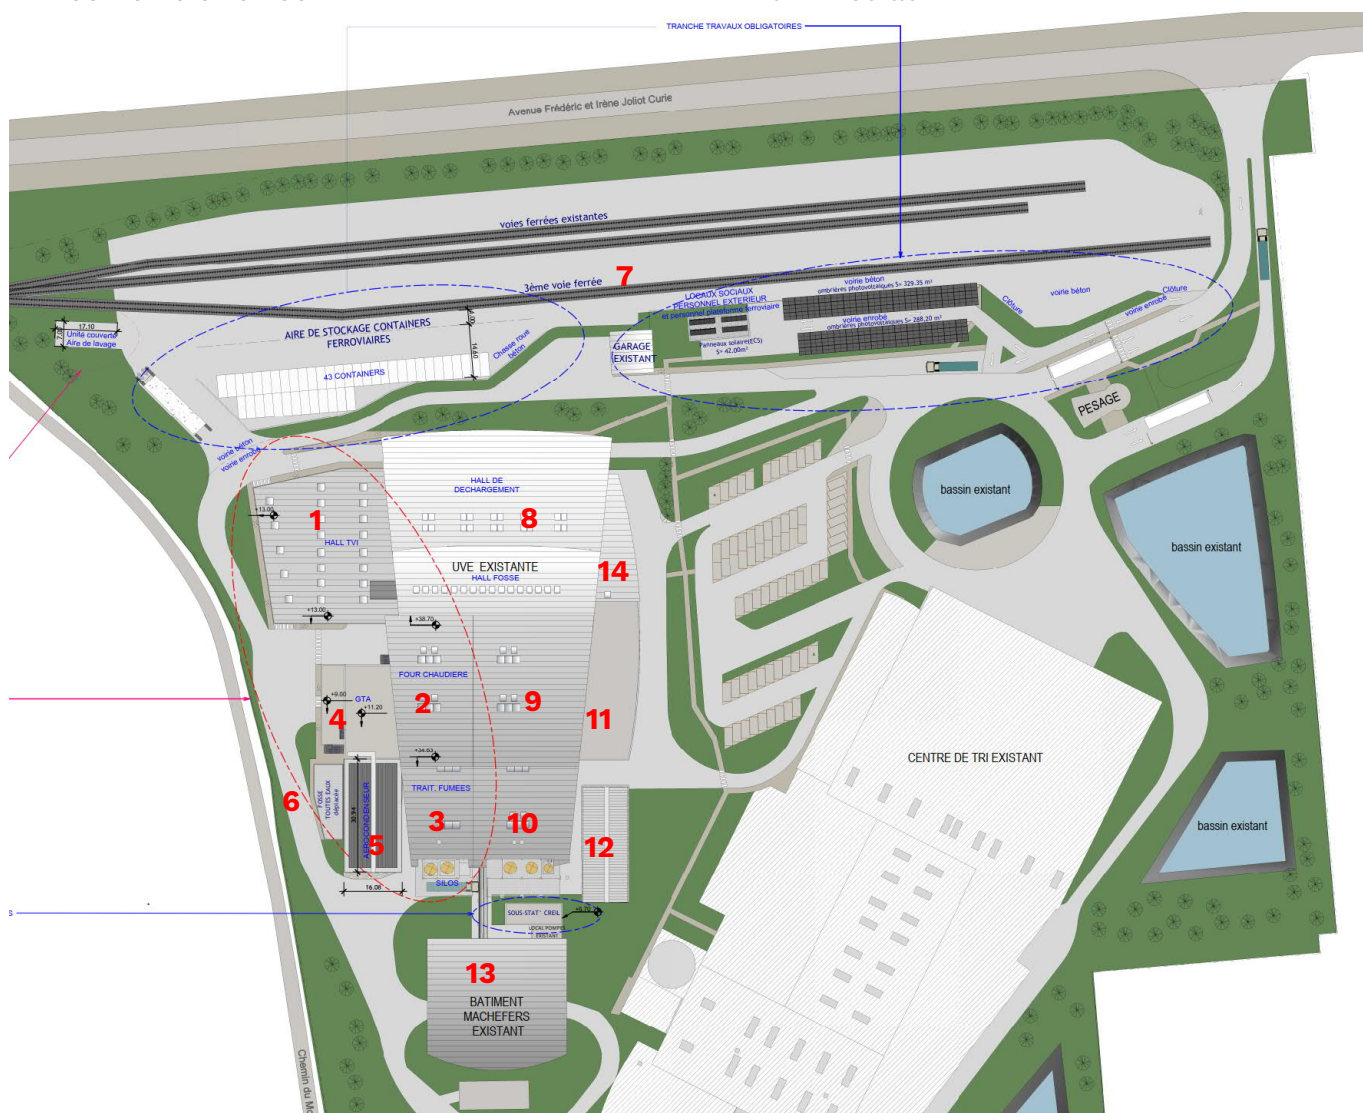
plan de masse du CVE de Villers-Saint-Paul
